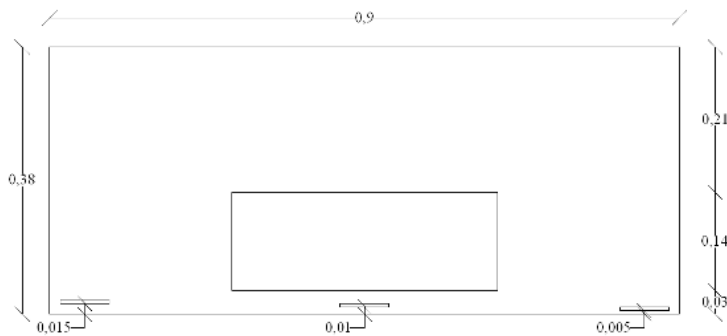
Sezione orizzontale del muro (dimensioni in m).
